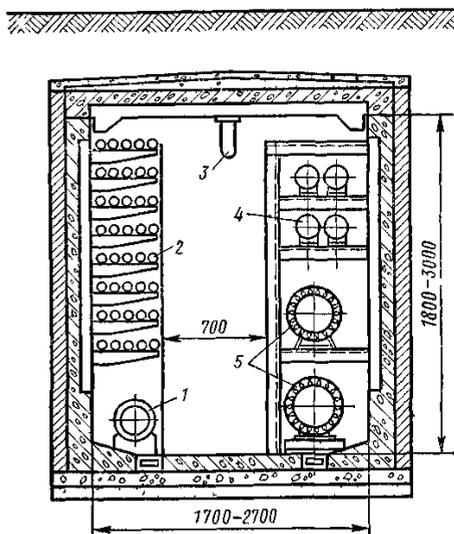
Проходной канал из сборных железобетонных блоков:
